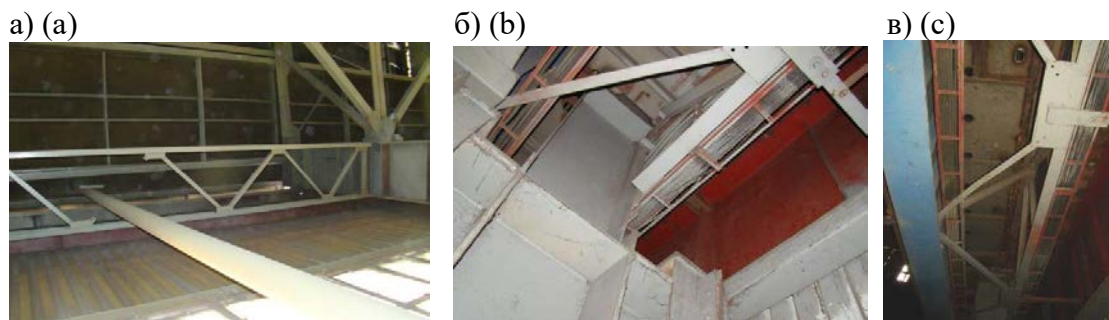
Отсутствие диагонали решетчатой распорки в уровне нижних поясов ферм между колоннами А12' и А13'(а); оторвана фасонка горизонтальной фермы тормозной конструкции подкрановой балки В10' – В11' в месте крепления её пояса к колонне В10'(б); общее искривление двух диагоналей горизонтальной связи тормозной конструкции В9' – В10'(в)
